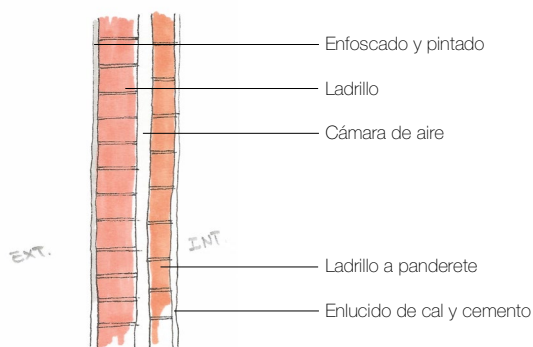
Sección de pared Norte y pared Sur (acceso), acabado enfoscado (autoría propia).
